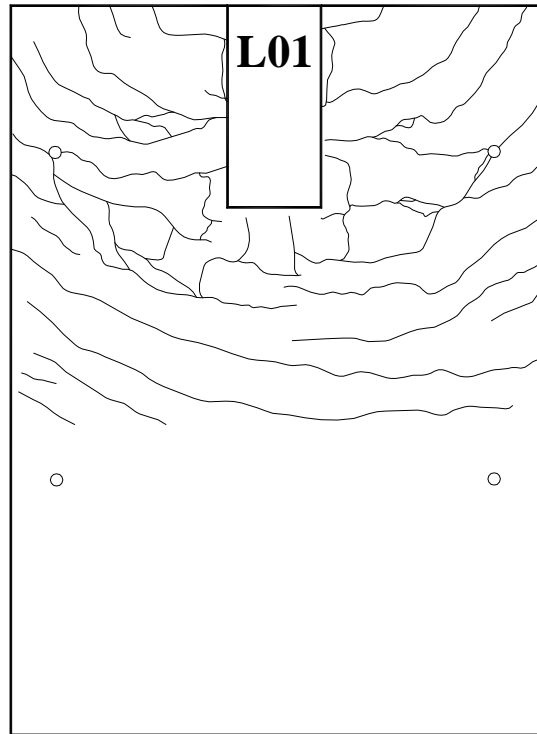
Padrão de fissuração da face inferior da laje – L1
